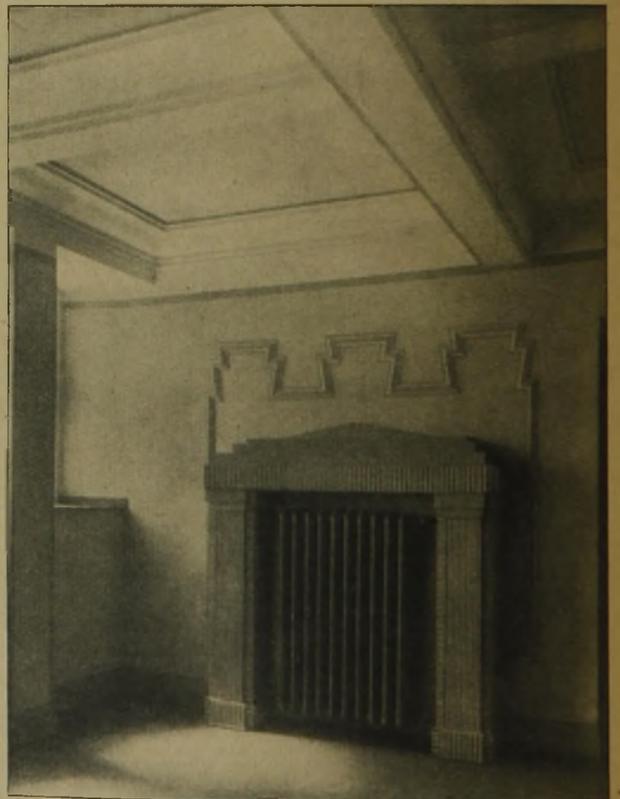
Ausschnitt aus dem Aufgang zur Kassenhalle.
